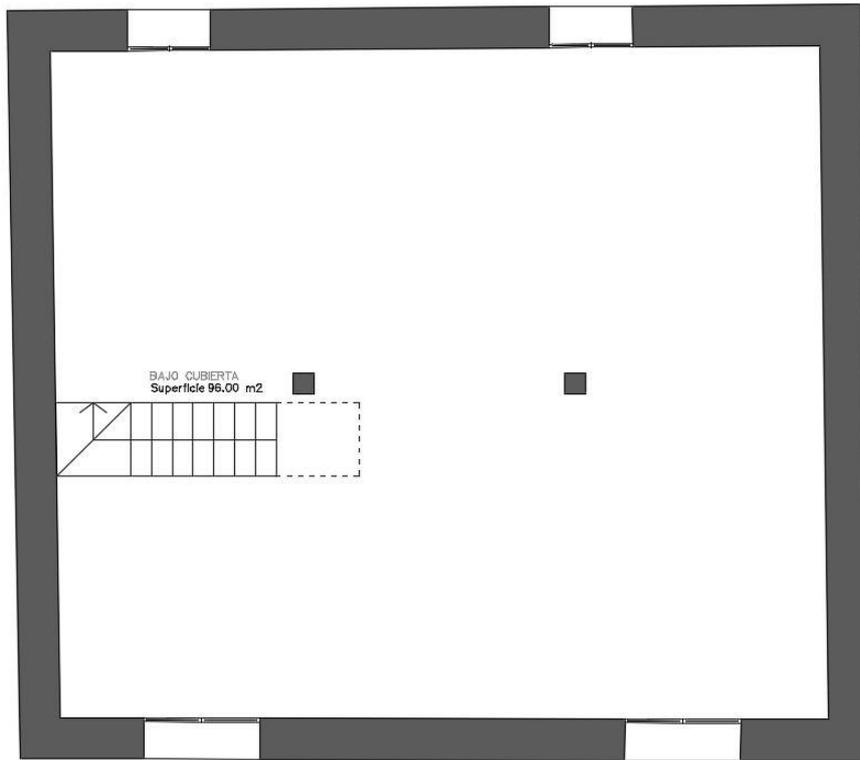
Planta Bajo Cubierta vivienda unifamiliar
